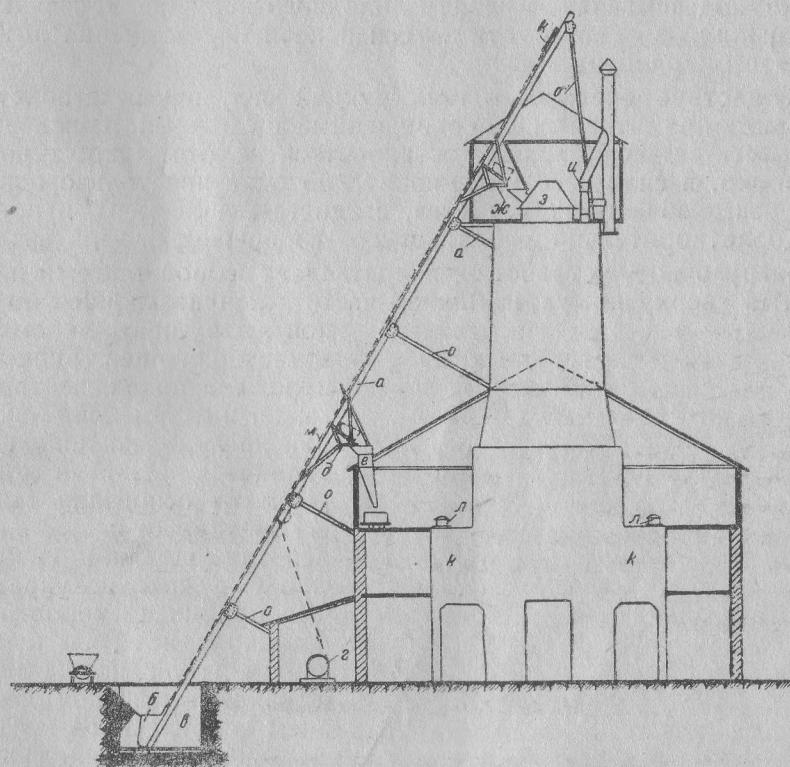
a*—скиповый подъемник; *b*—ковш; *в*—приямок; *г*—электролебедка; *д*—промежуточная разгрузочная стрелка для подачи топлива; *е*—бункер для топлива; *ж*—разгрузочная стрелка для известняка; *з*—загрузочное устройство печи; *и*—дымососная установка; *к*—полугазовые топки; *л*—загрузочные коробки для топлива; *м*—трос для подъема ковша; *н*—блок; *о*—опоры скипового подъемника.
